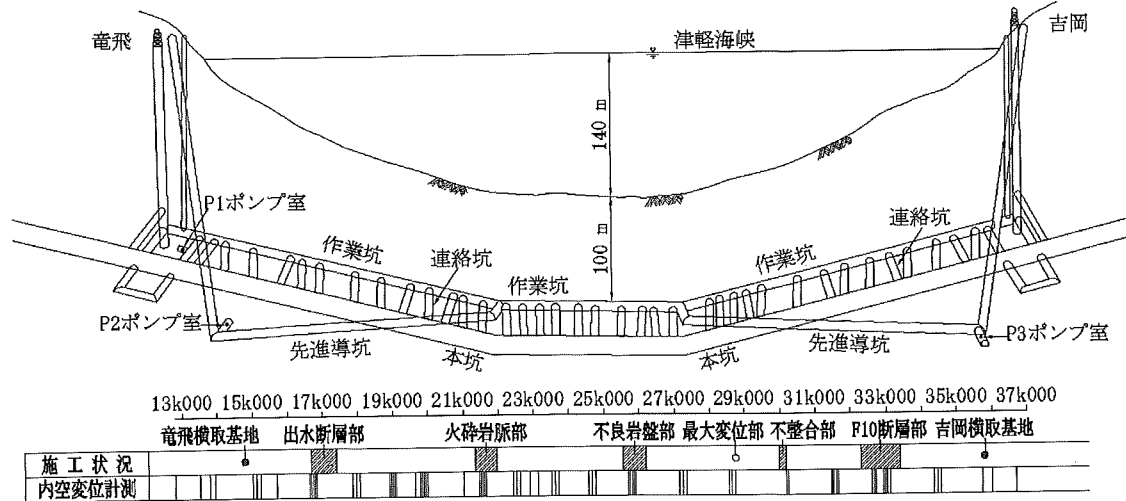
青函トンネル縦断面図(海底部)および内空変位計測位置
